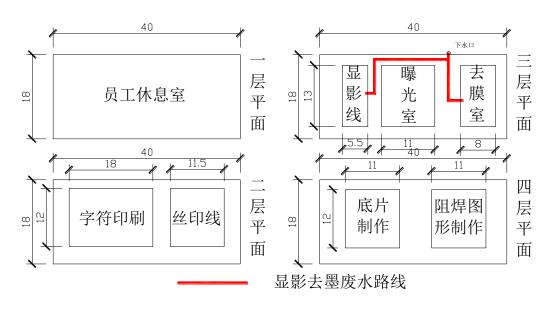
(b) 2#楼各层车间平面布置图(单位: m)
